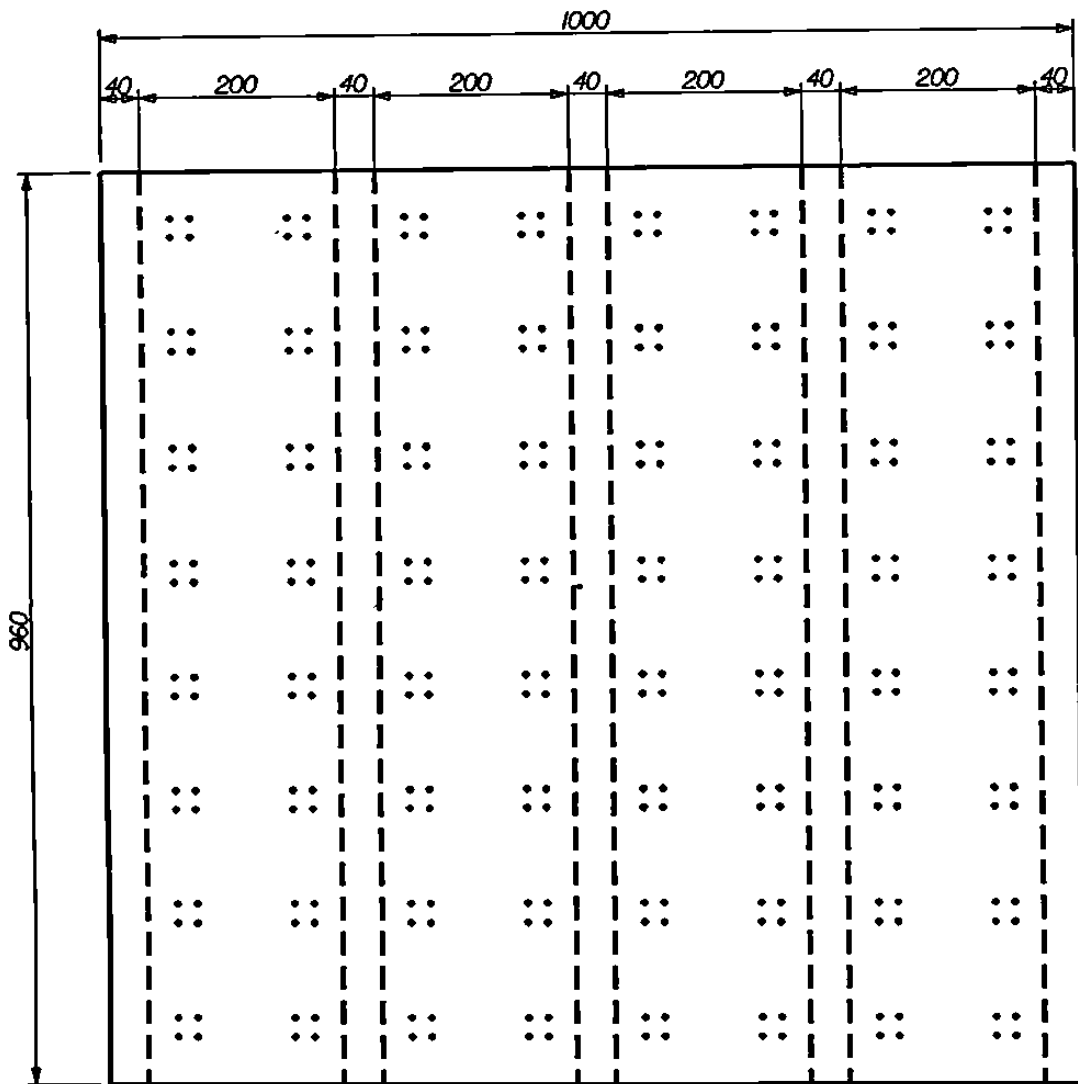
VISTA EN PLANTA DE LA LOSA
